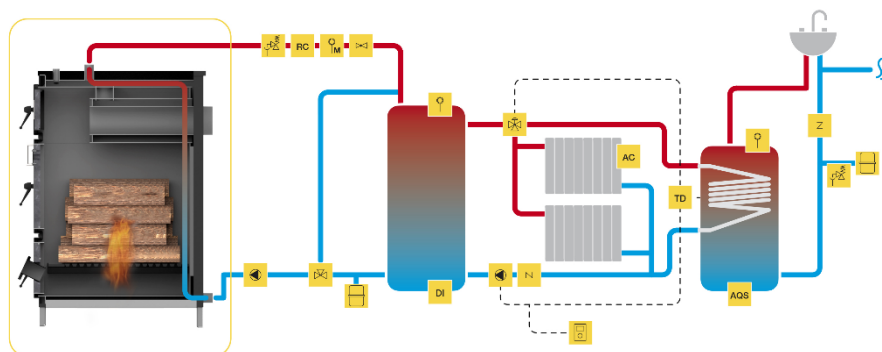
Schéma d'installation pour le chauffage central et l'eau chaude sanitaire
